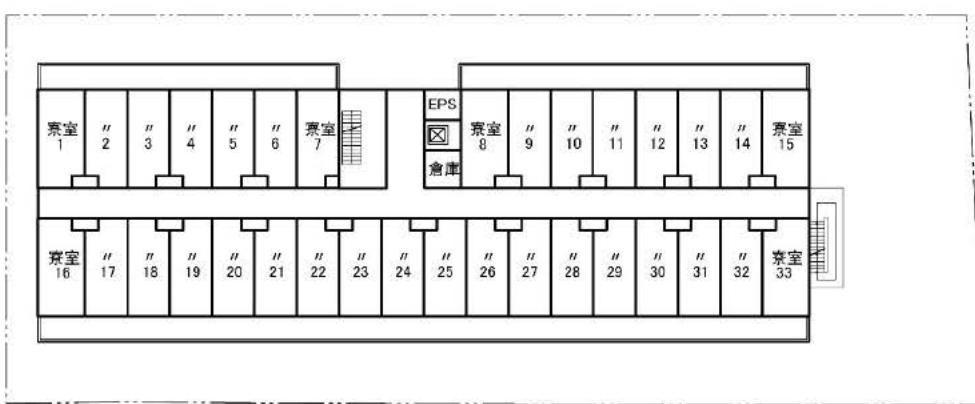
(3) 計画建築物平面図 (研究棟 B : 1階、2階)
